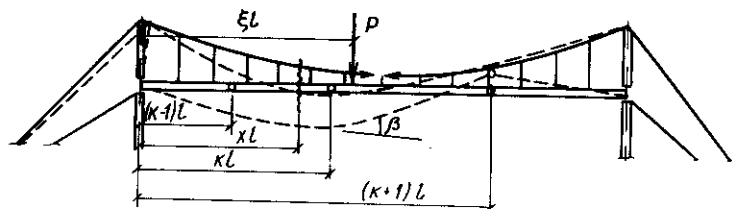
Расчетная схема ригеля с шарнирами в балке
